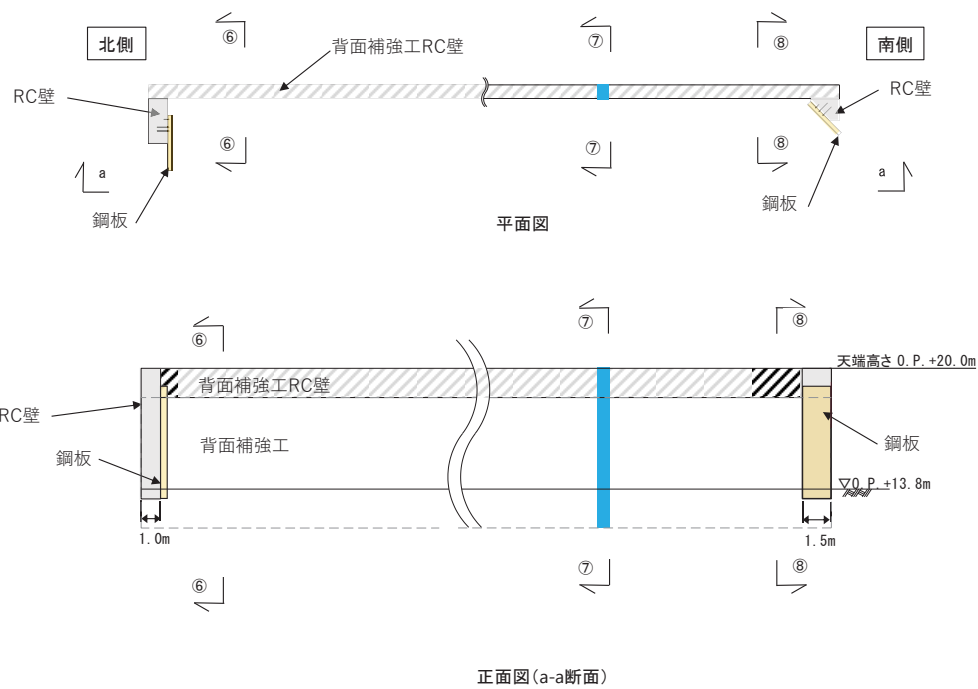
(1) 止水パターン⑥, ⑦, ⑧の構造概要(平面図, 正面図)
